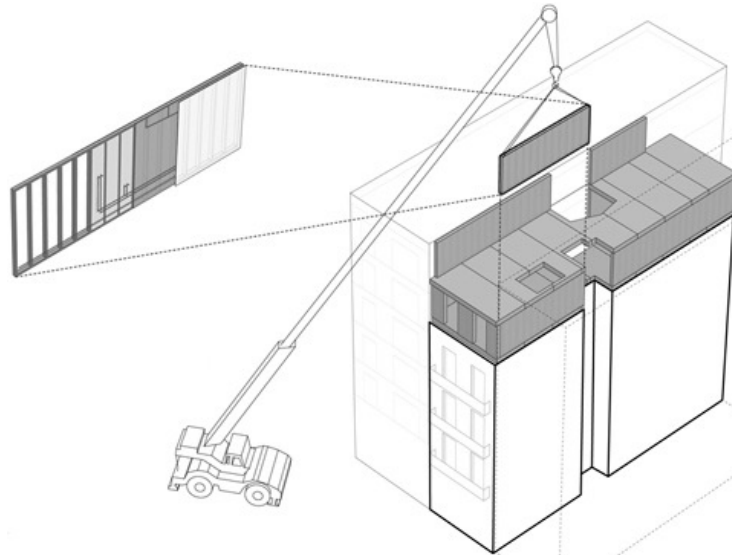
Sistema constructivo en paneles de madera, izado y montaje. Fuente: La Casa por el Tejado - Miba Architects
